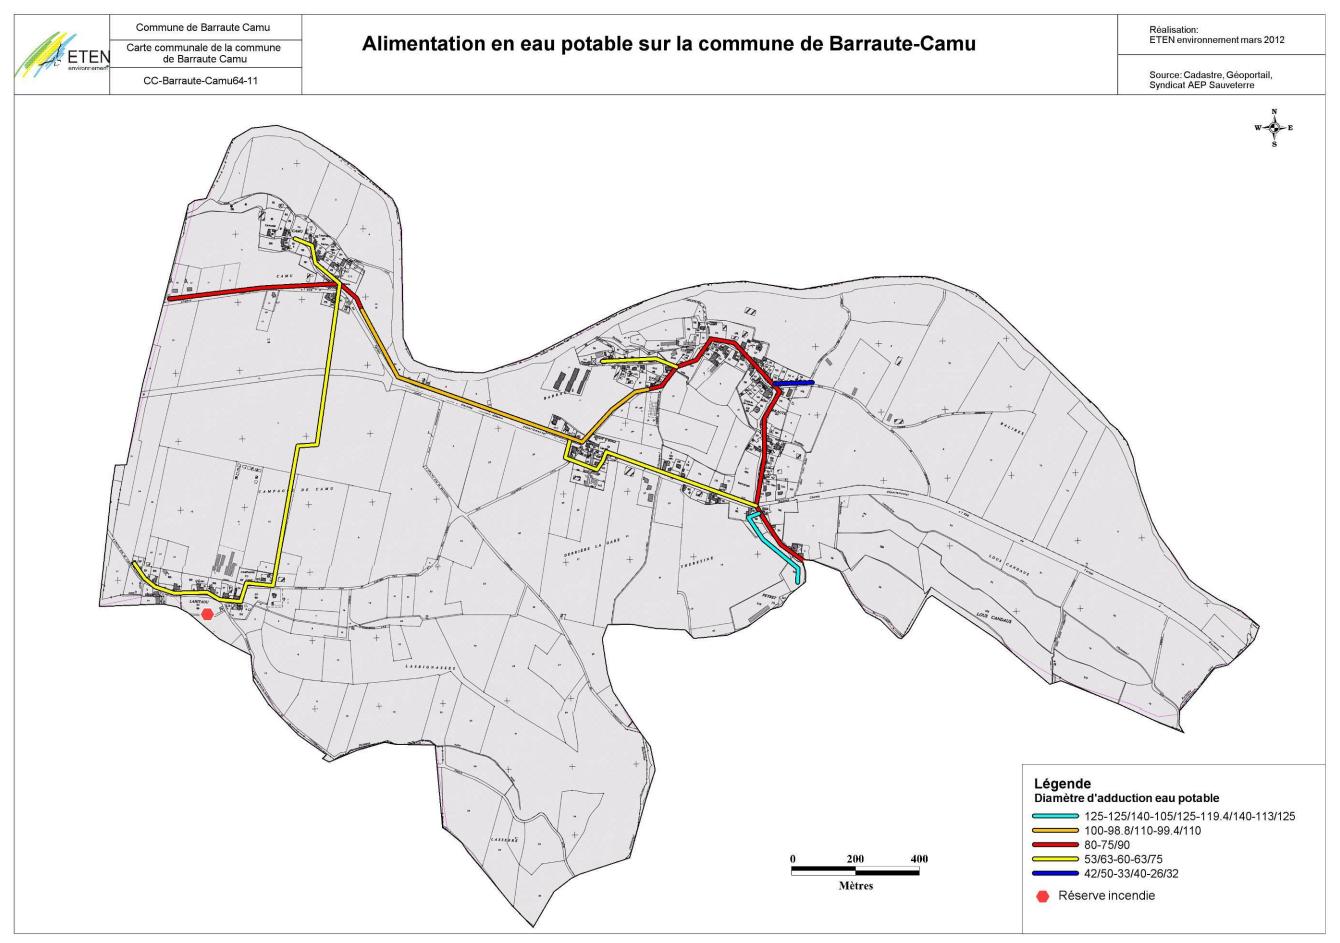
Plan du réseau AEP sur la commune de Barraute-Camu
